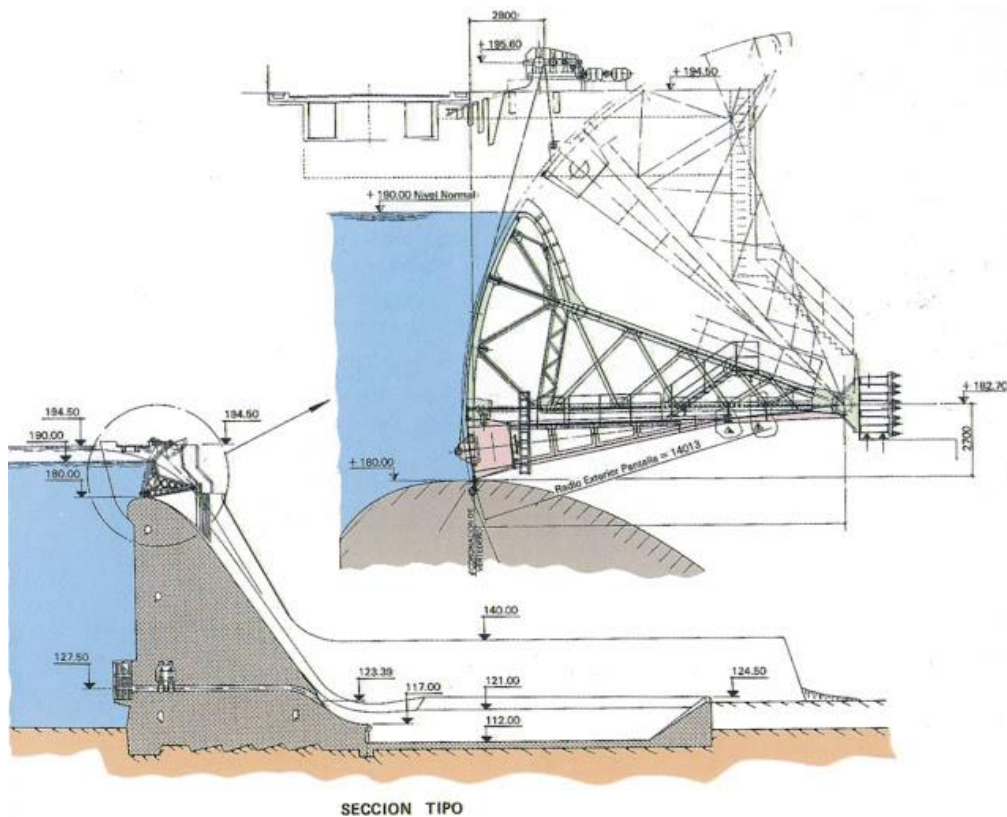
Sección de la presa y detalle de una de las compuertas. Fuente: <http://bioducto.blogspot.com>
